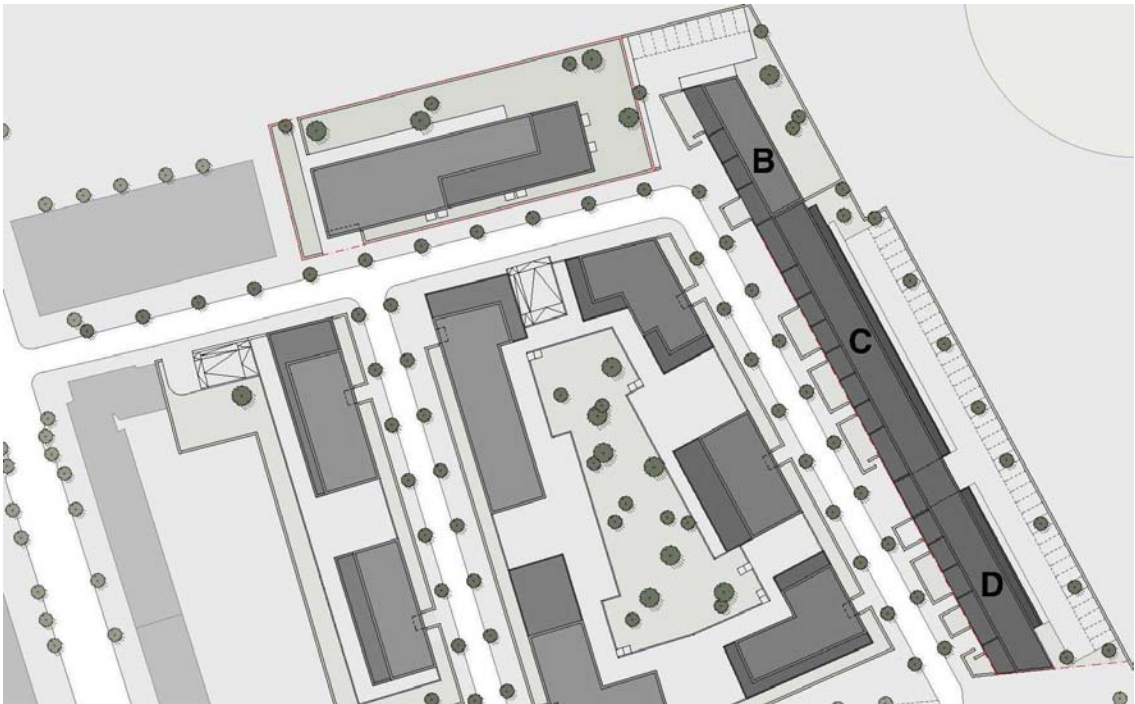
Lageplan geplanter Struktur Roter Sand Quartier
